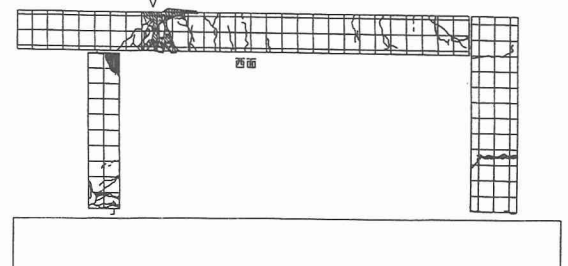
ひび割れ状況(I-8, H=2.5m, 2回目)
